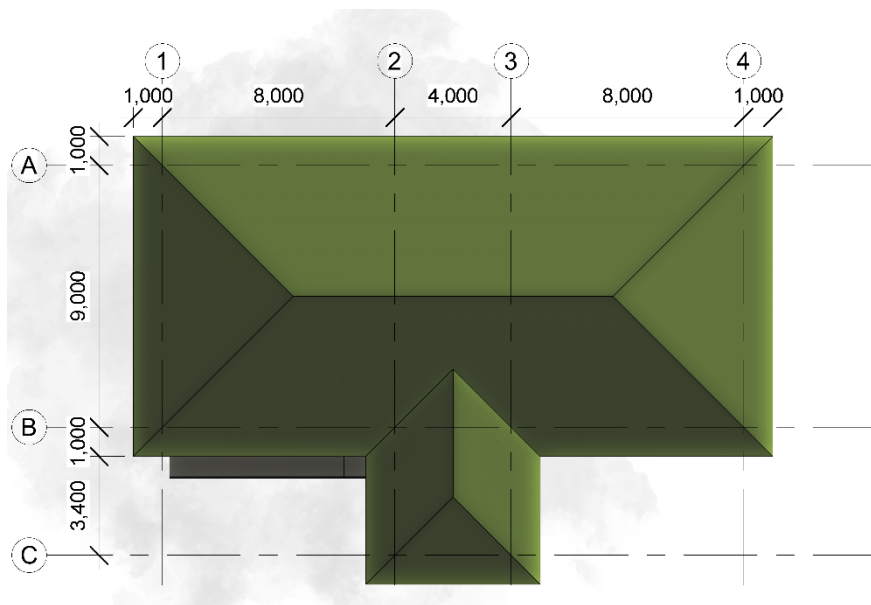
PLANTA DE TECHO EDIFICIO 1 | Elaborado por: El autor
